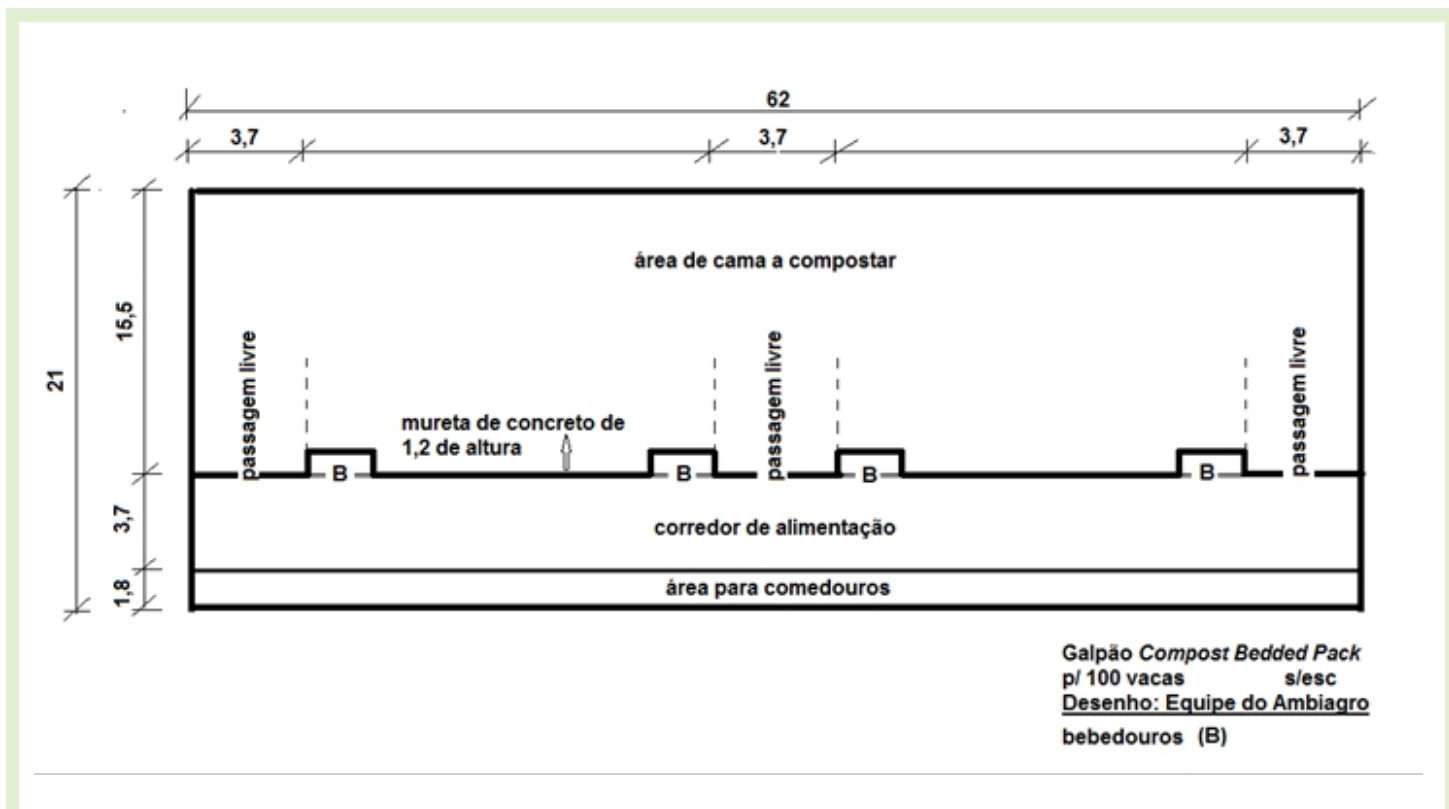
Modelo de planta baixa esquemática de uma instalação do tipo *Compost Barn* (Fonte: Souza et al⁵).
